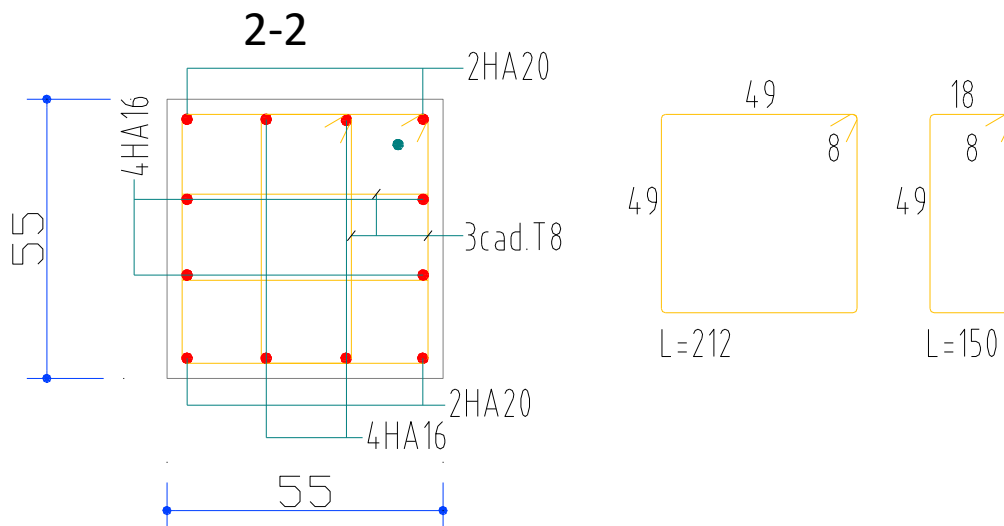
Coupe de ferrailage des poteaux 55 × 55 cm².
